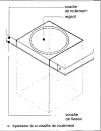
• Mise à niveau des ouvrages annexes (regard de visite).
